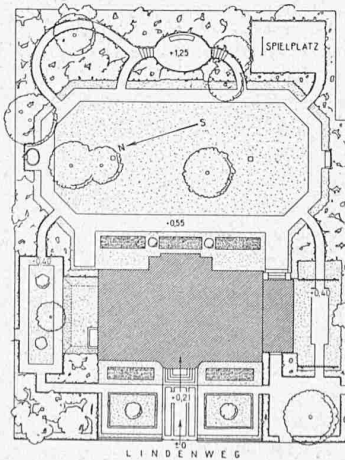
und 2. Grundrisse 1:400. — Abb. 3 (unten). Lageplan 1:800.
